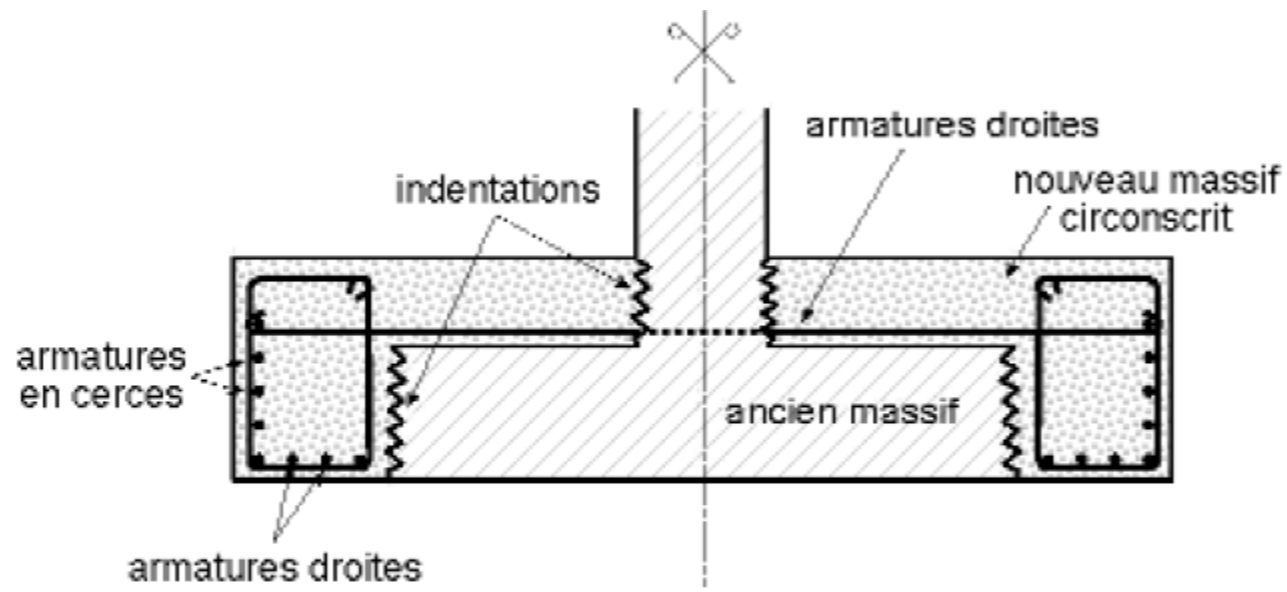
augmentation de la surface de la semelle avec surépaisseur.
